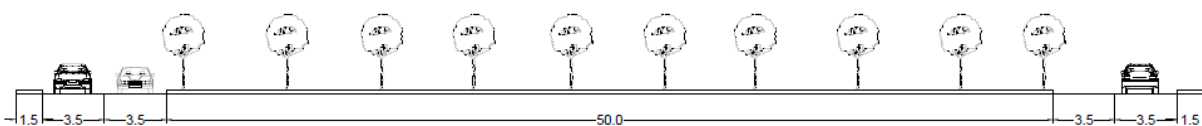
Sección Transversal Av. Del Zoológico. (Fuente: Elaboración Propia).
